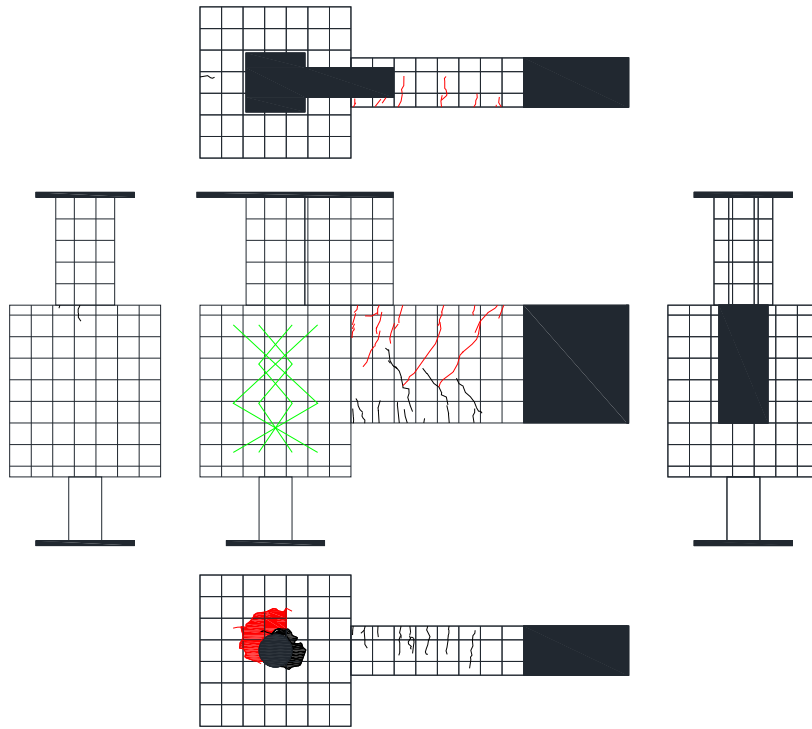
試験体 DR-3 ひび割れ状況 (7Cycle)
